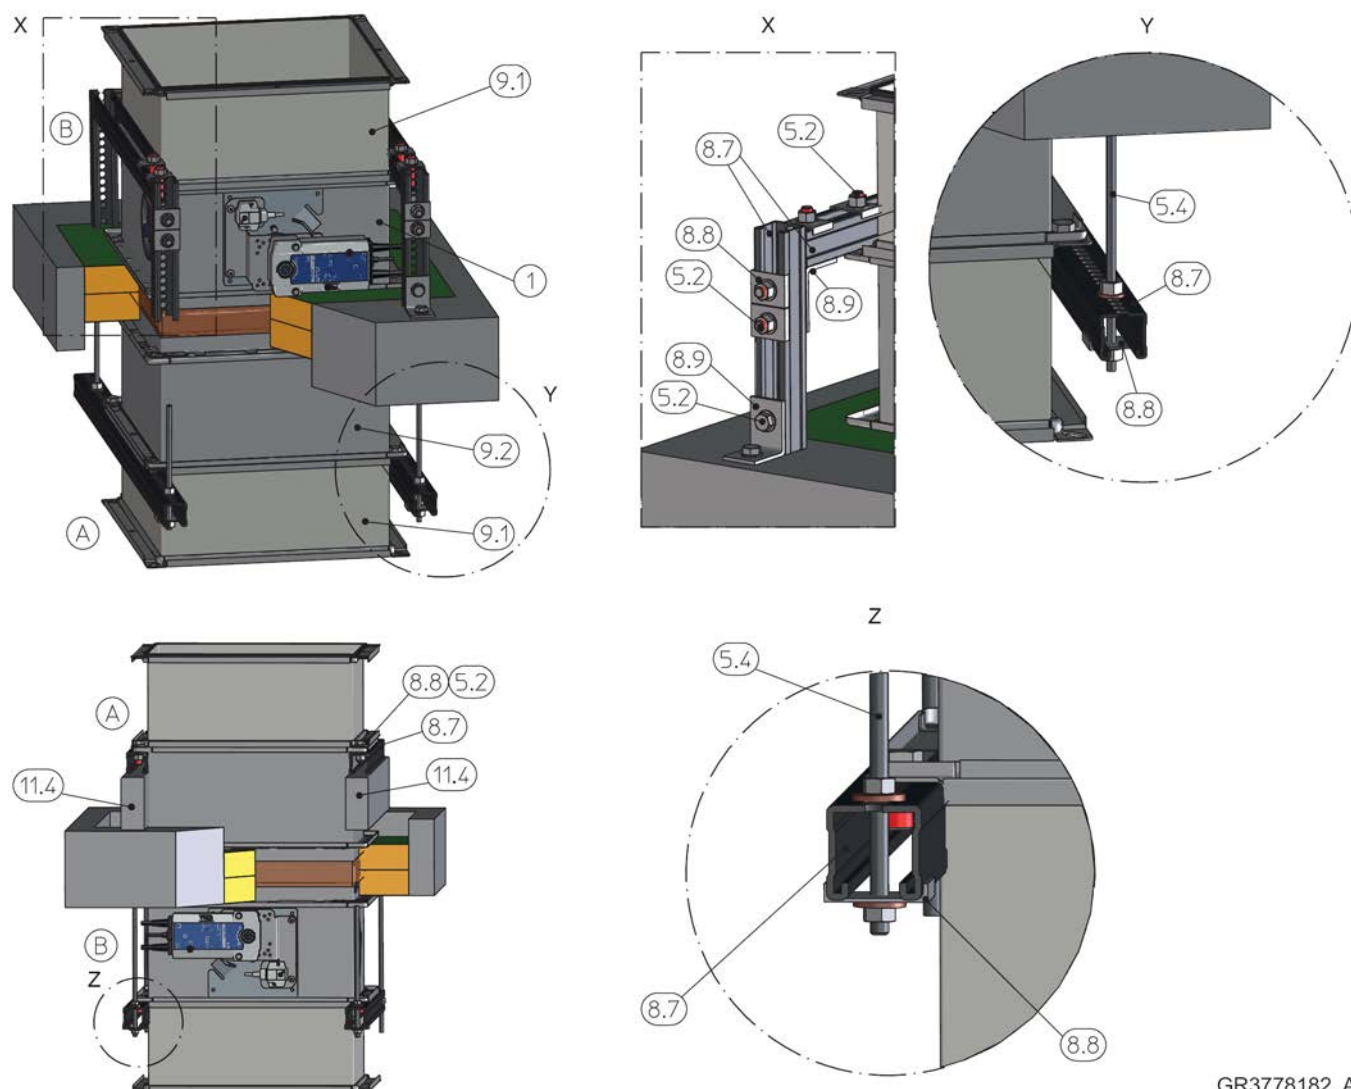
Tørr mørtelfri montasje med montasjesett WE
